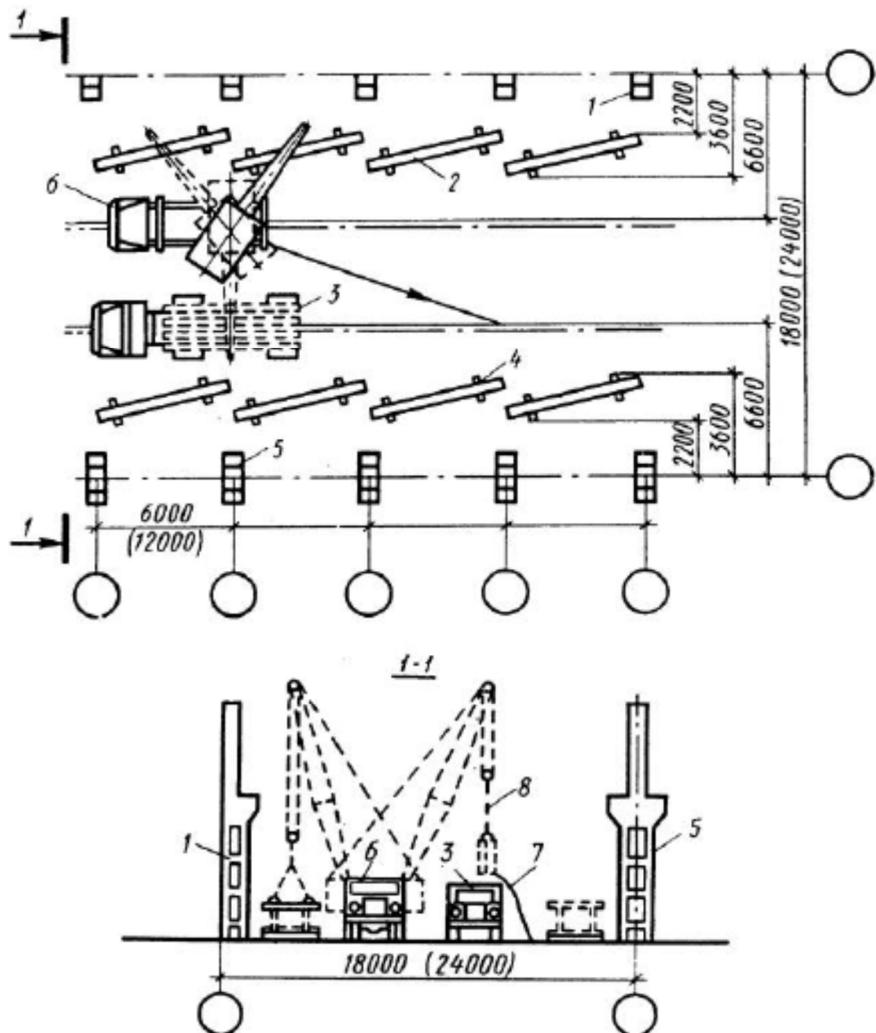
Схема выгрузки и раскладки подкрановых балок пролетом 6 и 12 м: 1 - колонна крайнего ряда; 2 - подкрановая балка; 3 - балковоз; 4 - деревянная подкладка; 5- колонна среднего ряда; 6 - автомобильный кран; 7 - оттяжка из пенькового каната; 8 - строп
